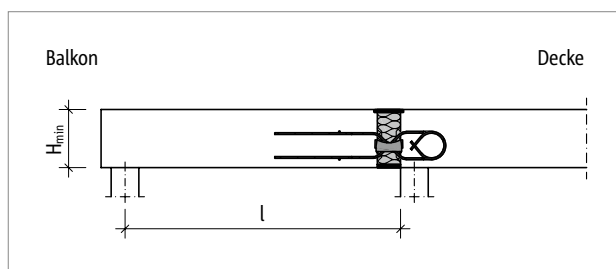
Schöck Isokorb® T Typ QL-VV1: Statisches System
